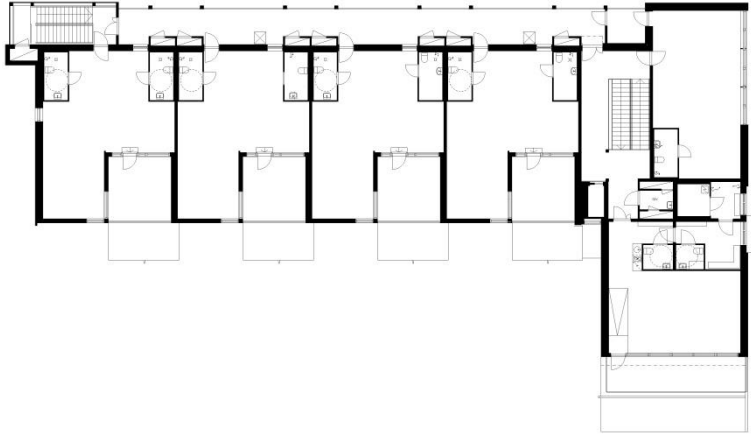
Planta quinta con *raw spaces* de 81 m², 2009
